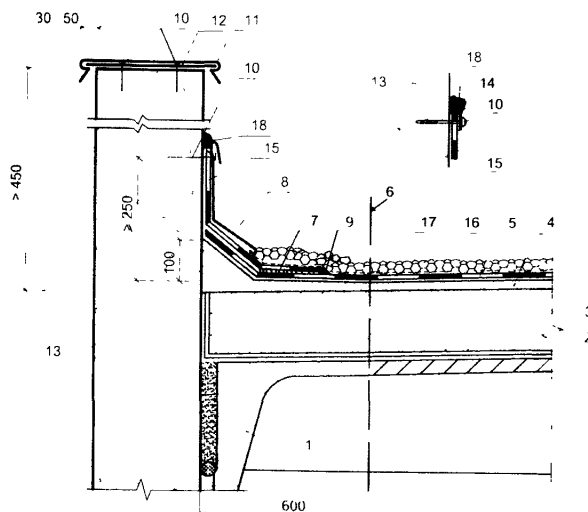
Примыкание кровли к парапету высотой более 450 мм
